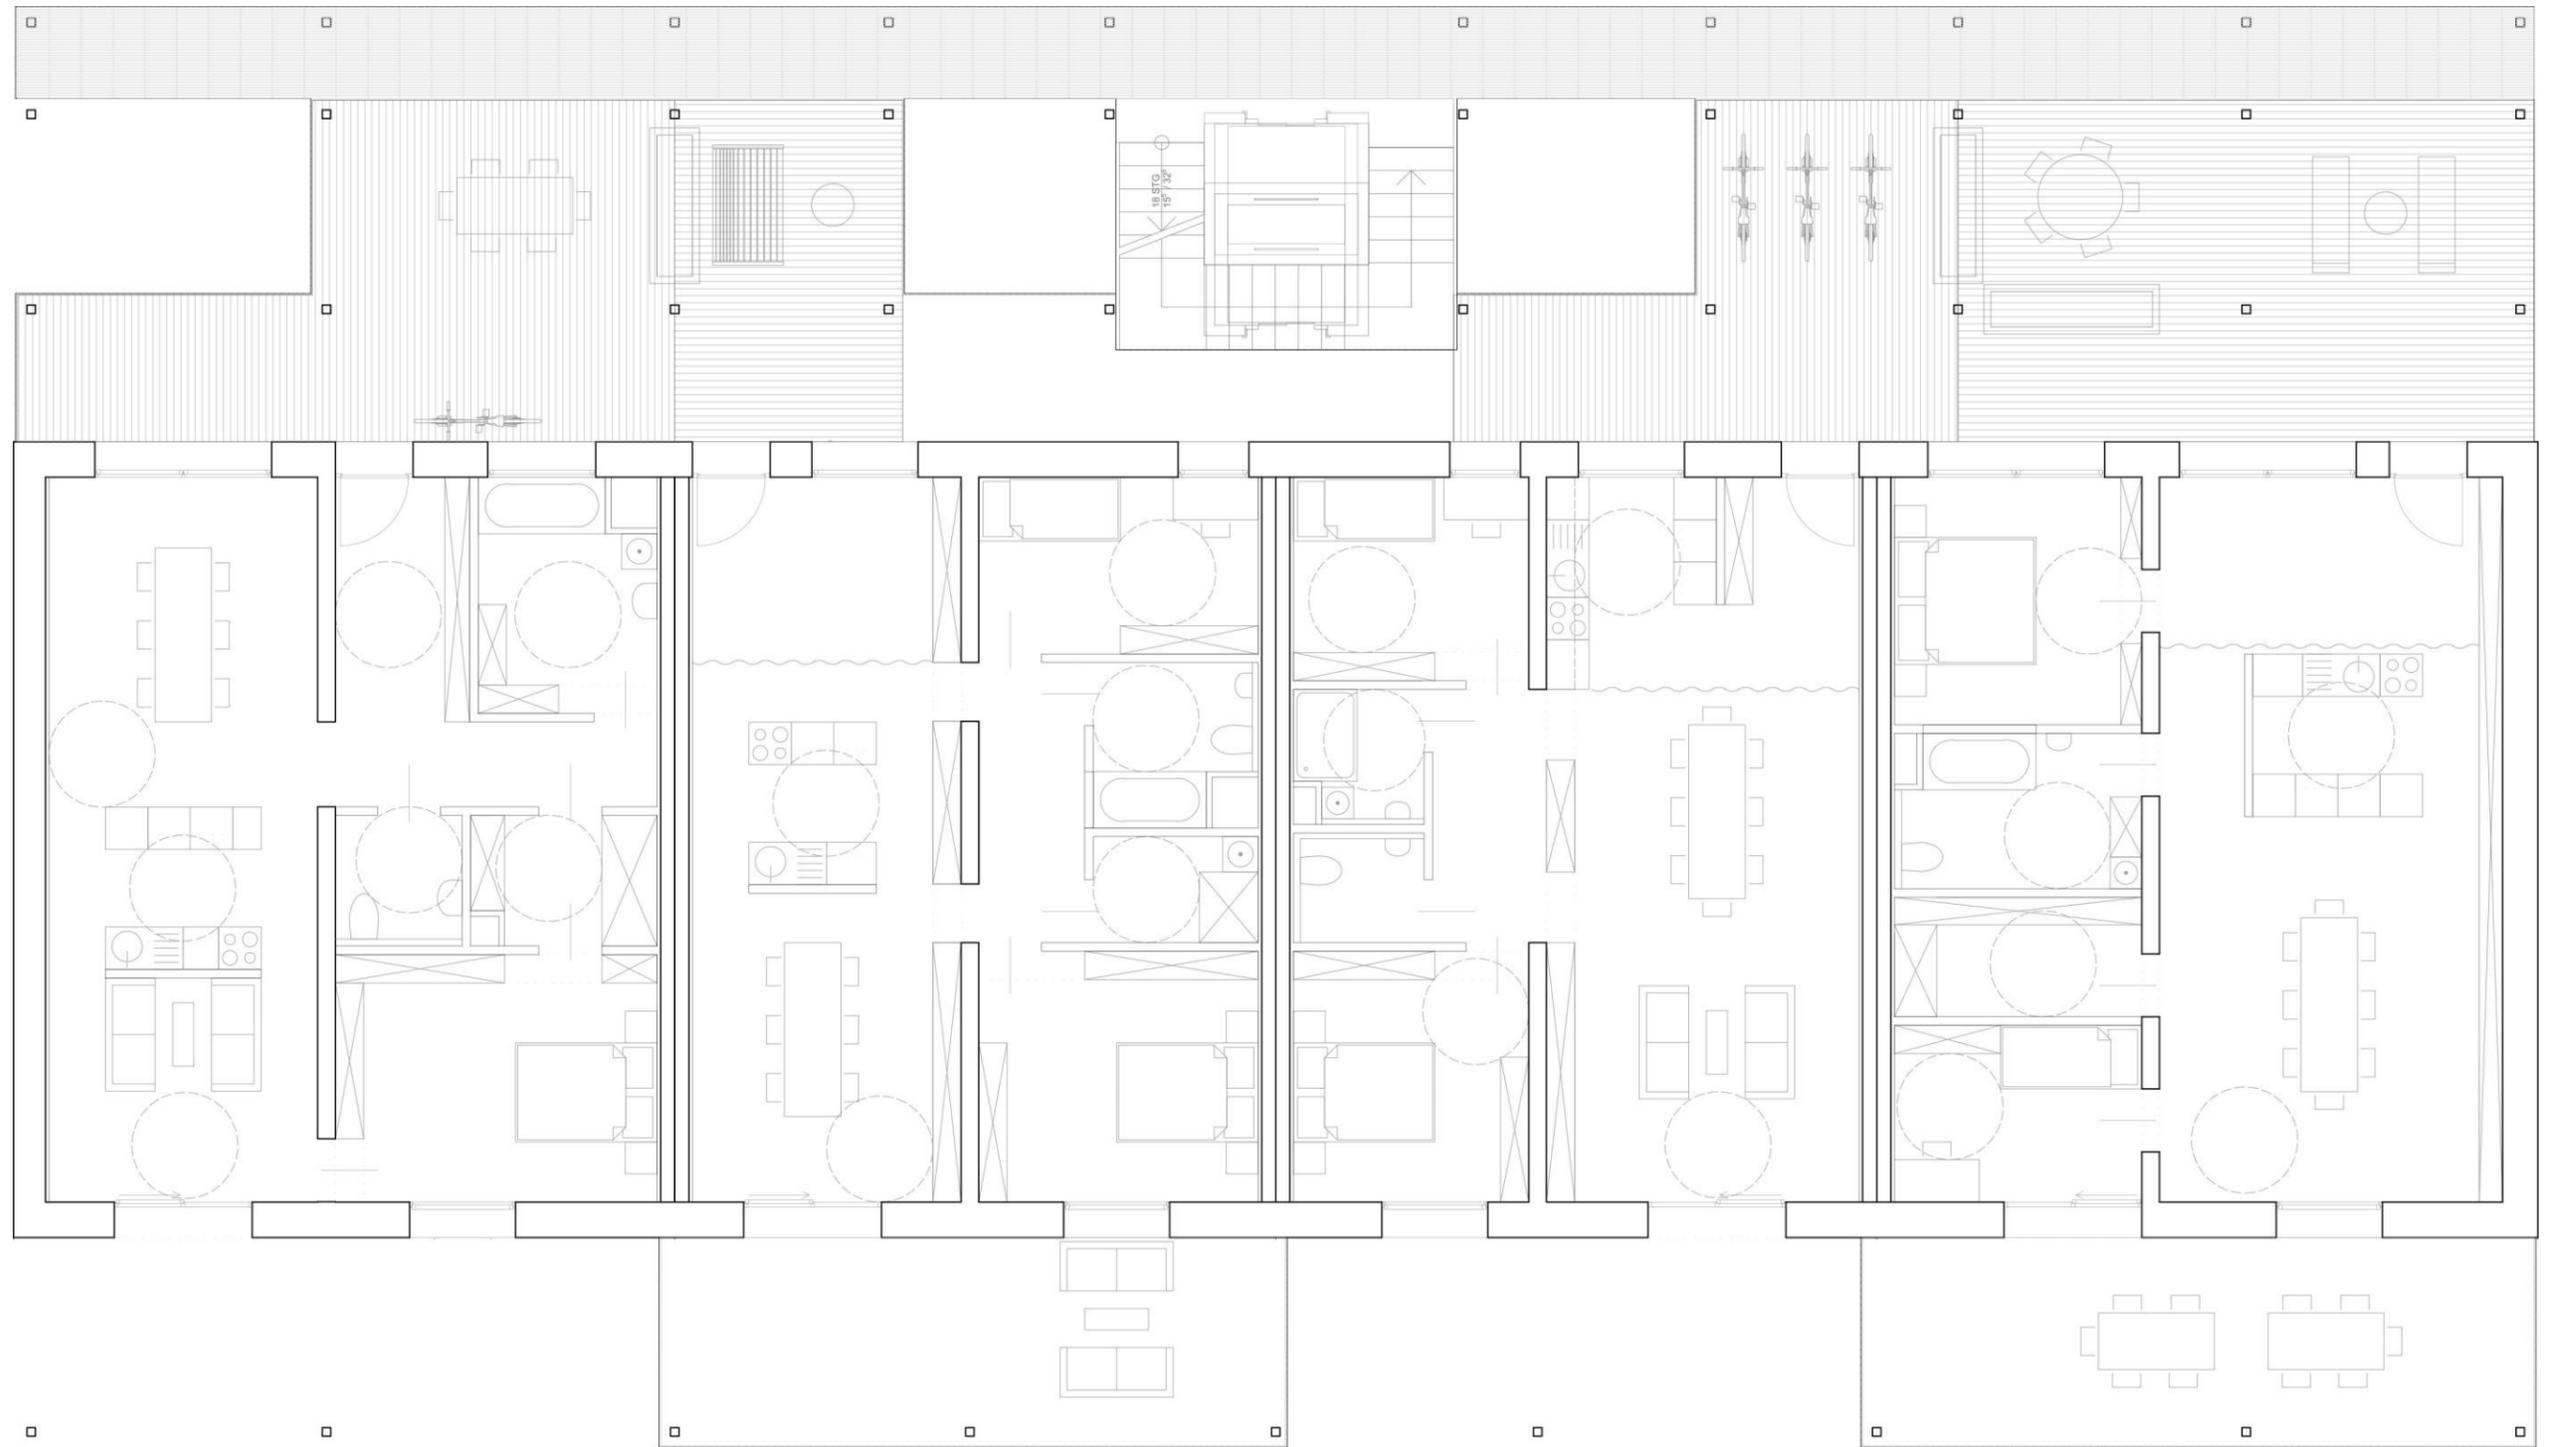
Grundriss 2.Obergeschoss M1:100
